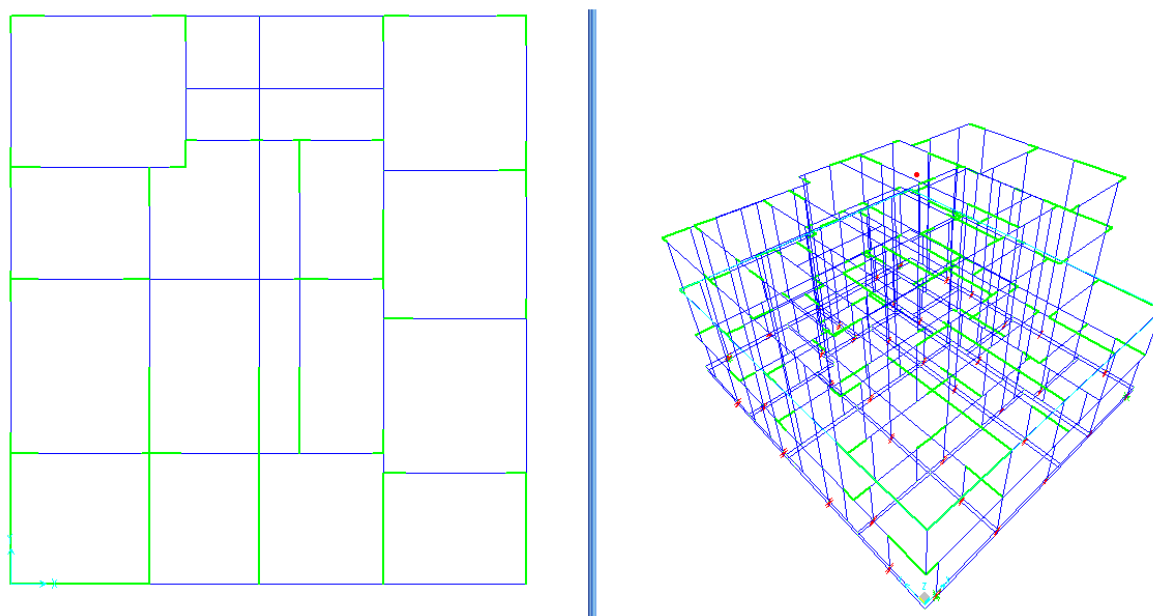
Pianta della II elevazione (a) e modello 3D (b) della struttura con evidenziati i tratti rigidi in verde.
